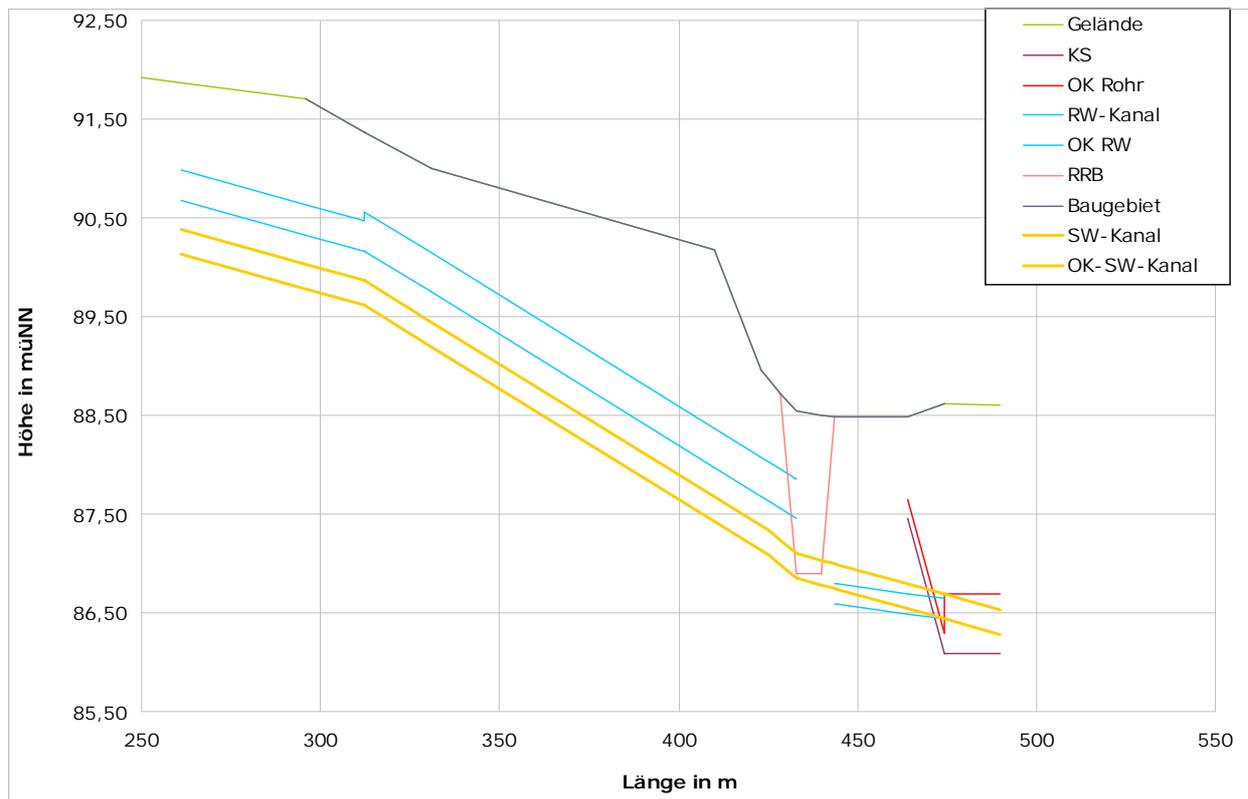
Zielentwässerung im geplanten Wohnbaugebiet nördlich der Schleestraße, hier zusätzlich mit Anbindung an die Legdener Straße
